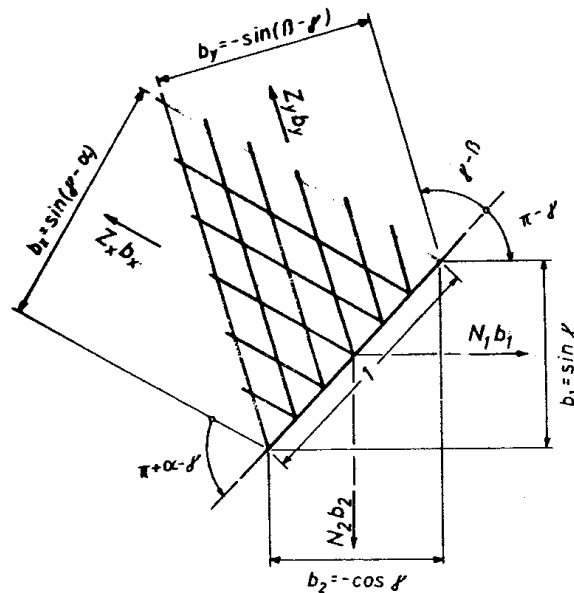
Schnitt parallel zur dritten Bewehrungsschar z
